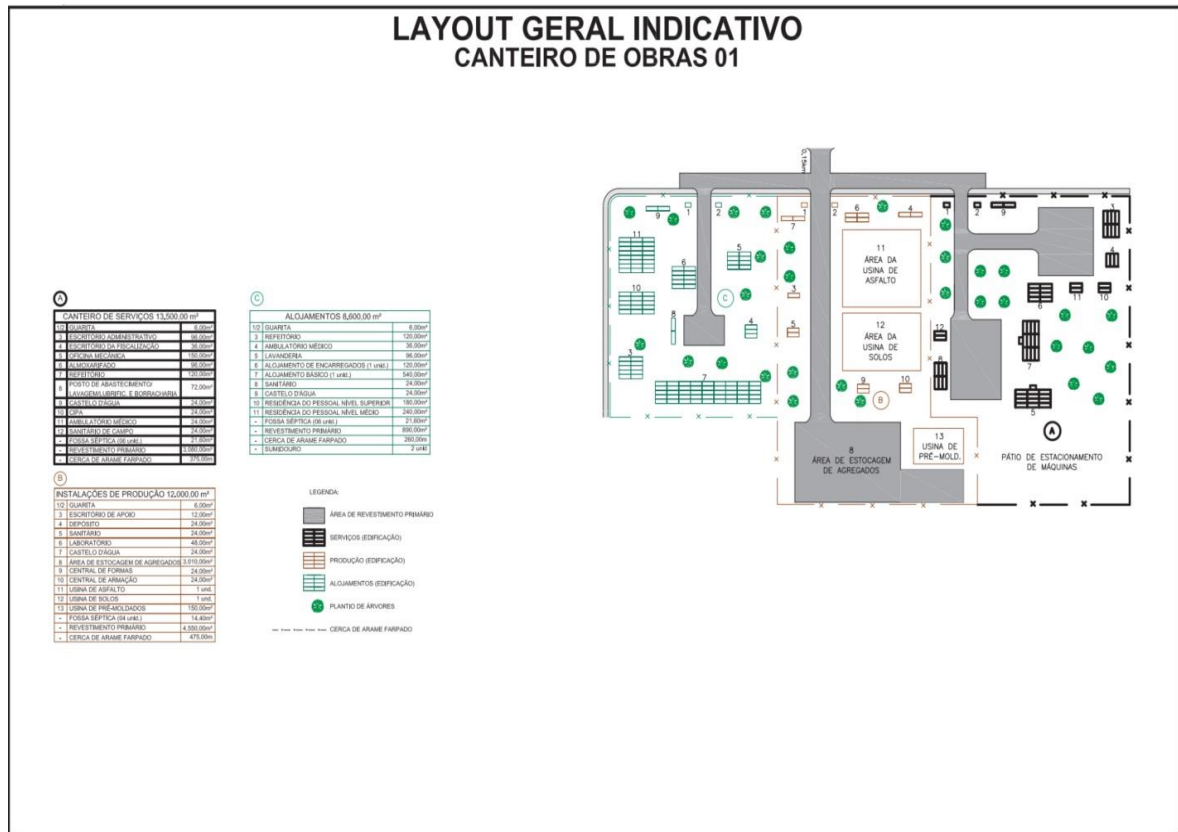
Estrutura prevista para o canteiro de obras no Segmento C da BR-242/MT.
